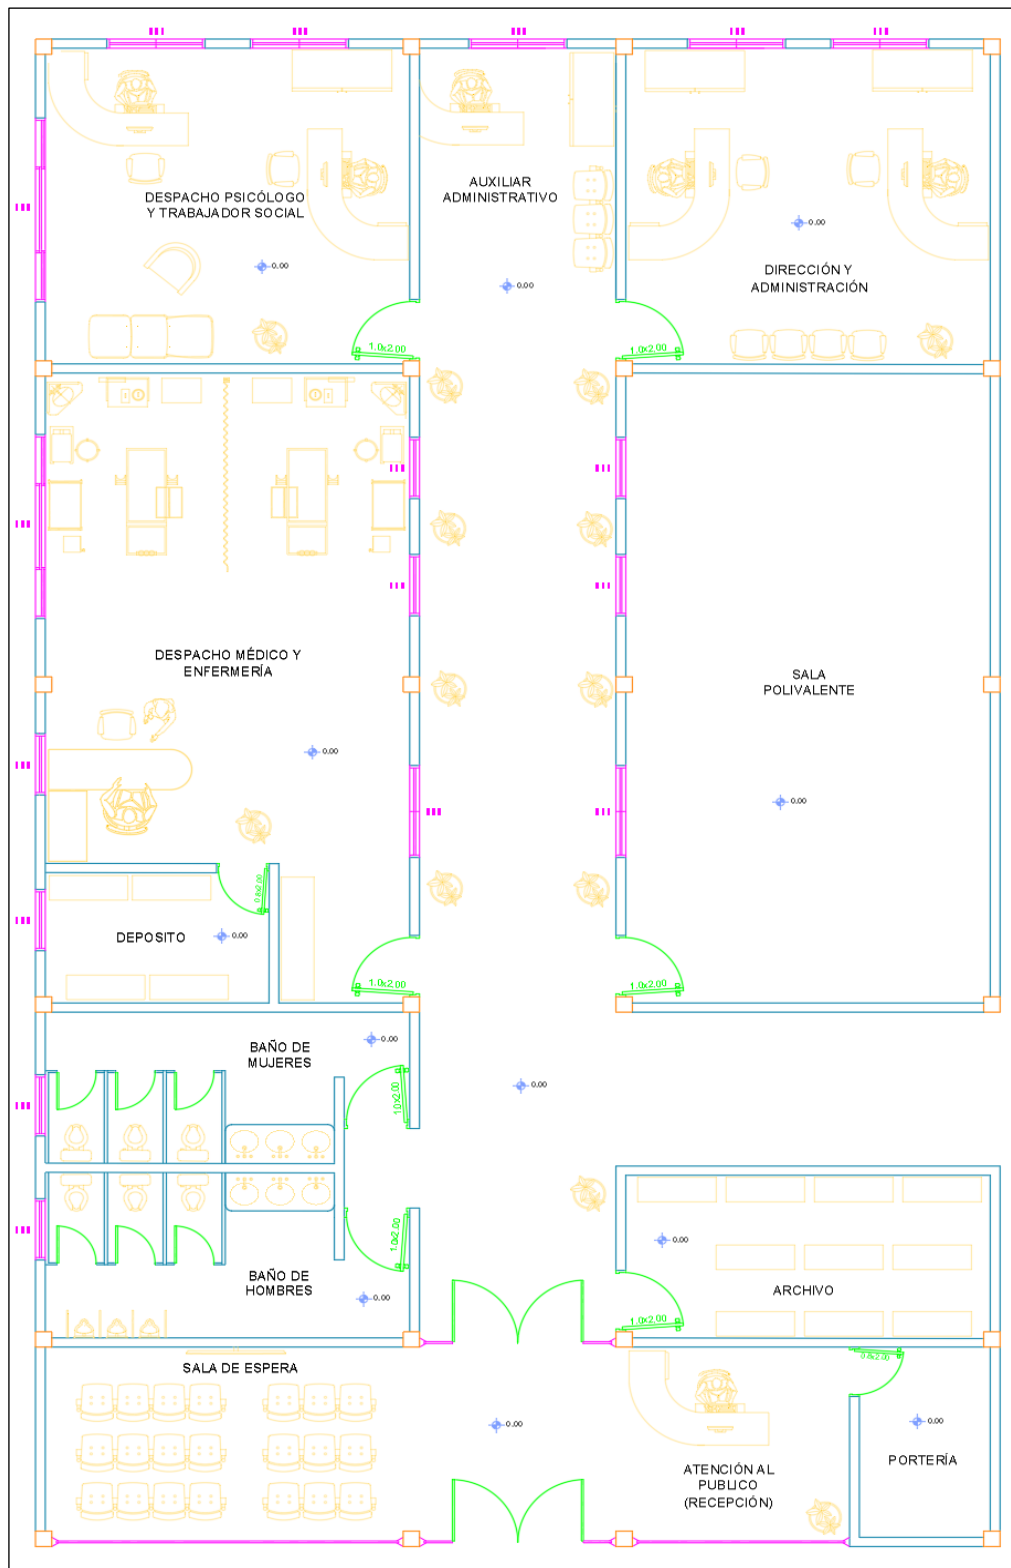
Diseño arquitectónico de la estructura 1 del C.D.I. Fuente: Autores del proyecto.
